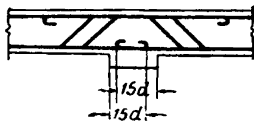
Стык нижней продольной арматуры на опорах многопролетных балок при отсутствии необходимости учета сжатой арматуры в опорных сечениях (в случае применения для продольной арматуры стали периодического профиля на концах стержней крючки не устраивают)
